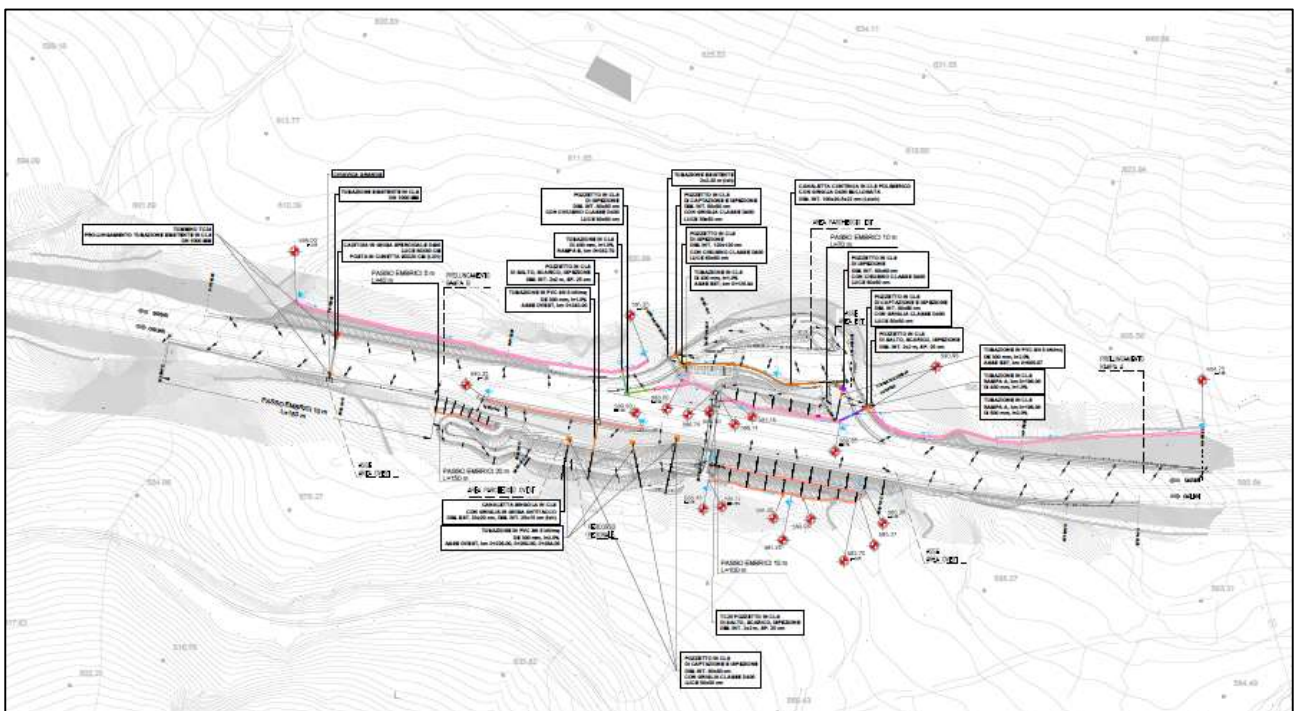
Stralcio planimetrico intervento V10-Area archeologica S. Barbara al km 144+500
